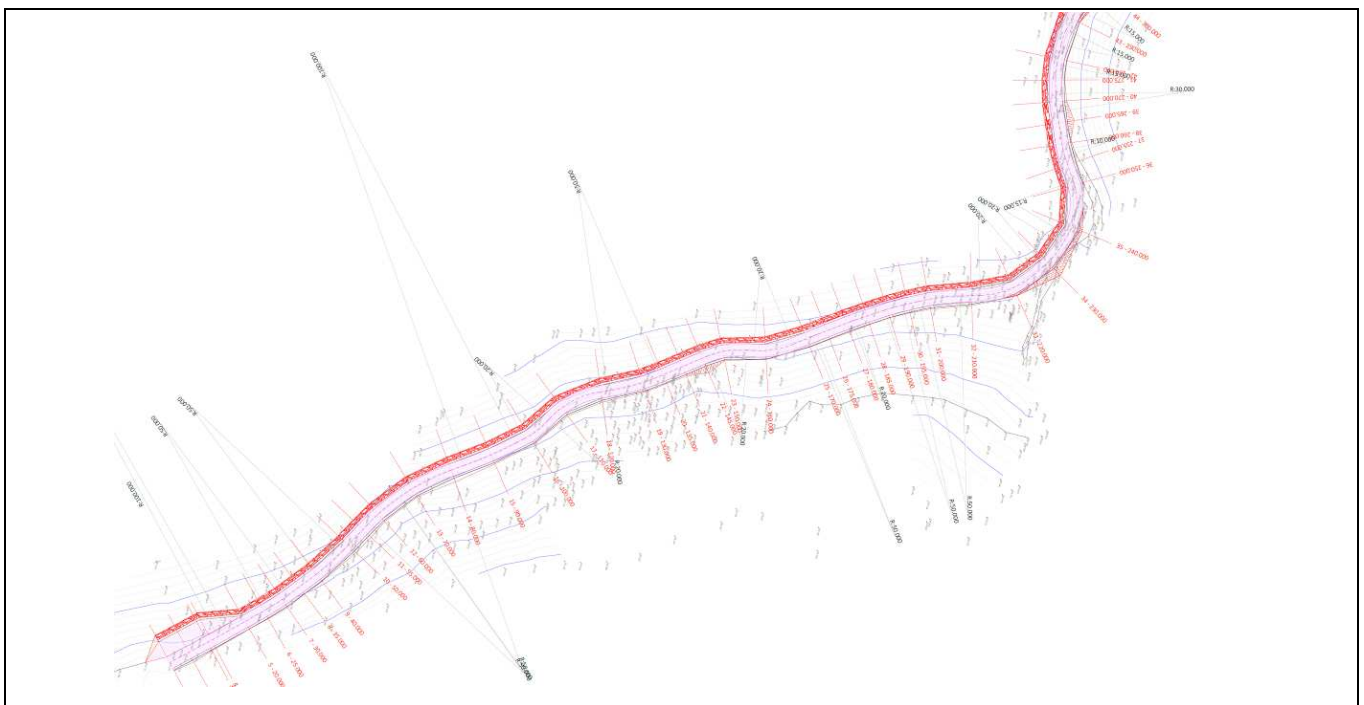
estratto planimetrico tratto iniziale pista in progetto [tavola B3 Studio Maraffio]
